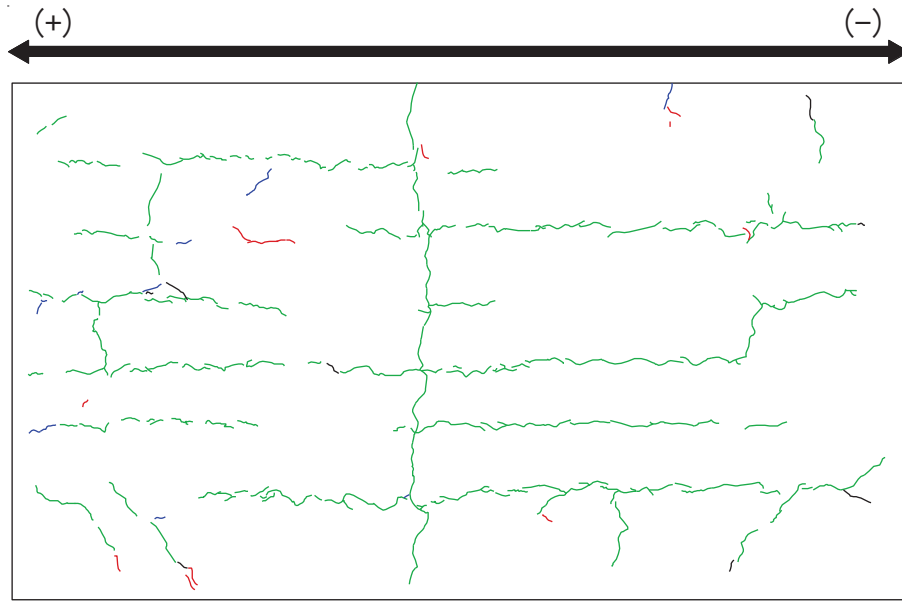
(3) 乾燥試験体 [1] 1/5000rad. におけるひび割れ図
